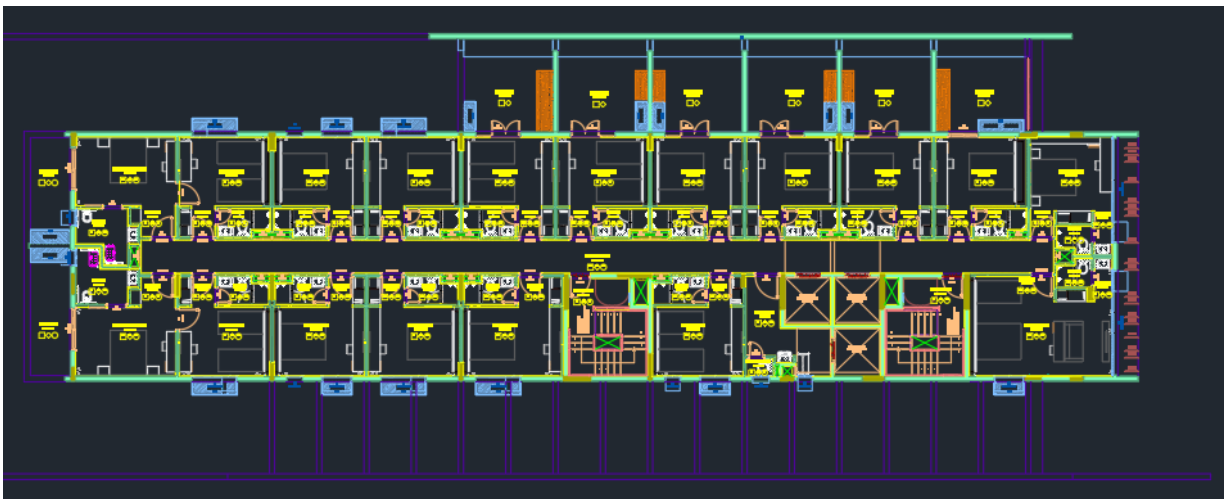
Arquitetura do 2º Pavimento. (Fonte: OSPA, 2019)
